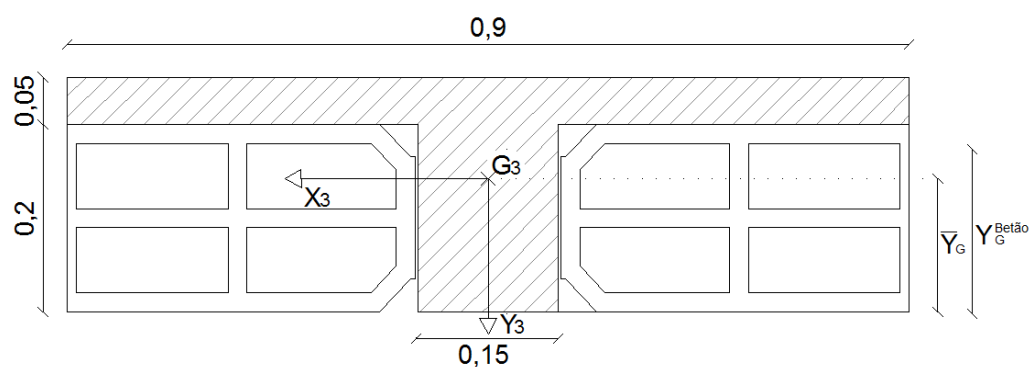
Secção transversal considerando os blocos de aligeiramento em corte longitudinal (Corte B-B')
